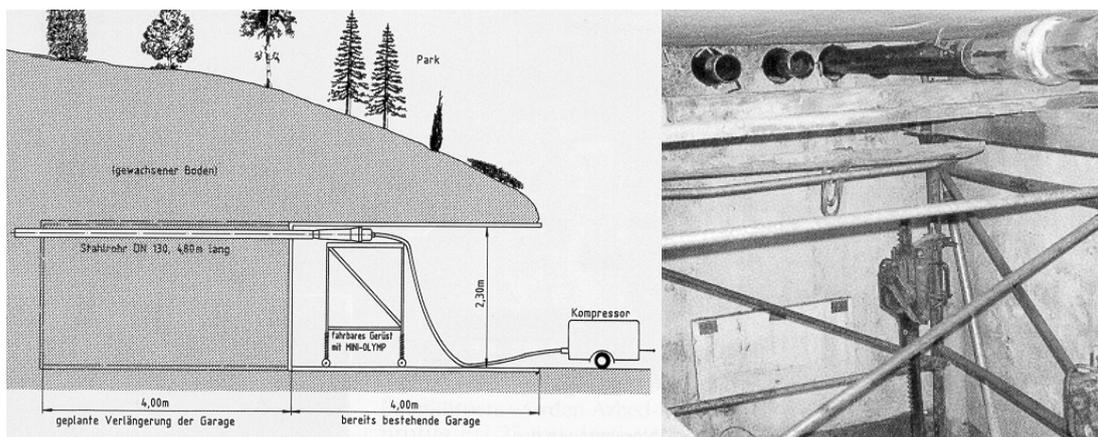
Anwendungsbeispiel: Unterfangung [1]
